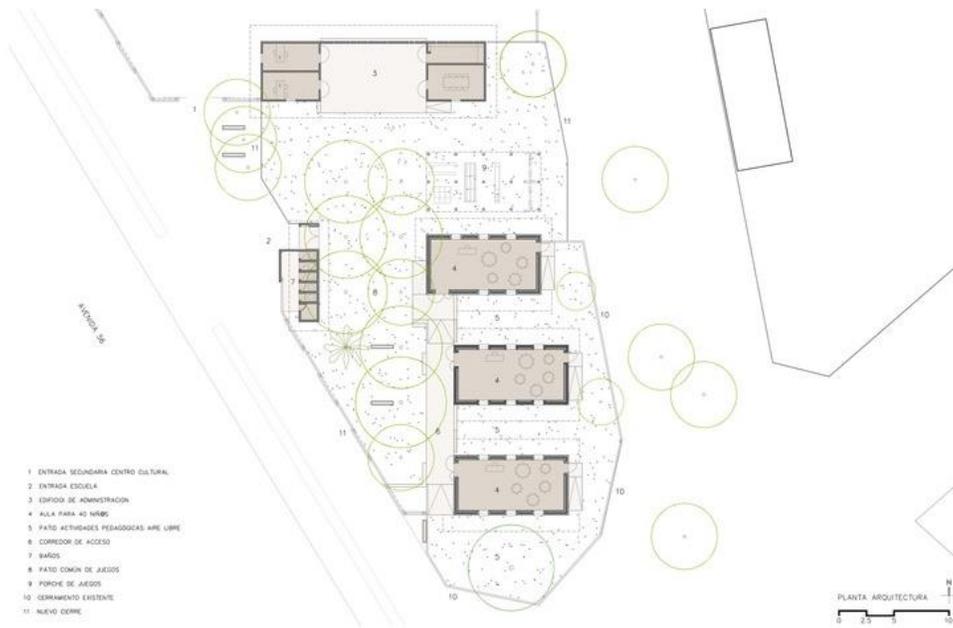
PLANIMETRIA ESCUELA DE NIÑOS LAAF.
